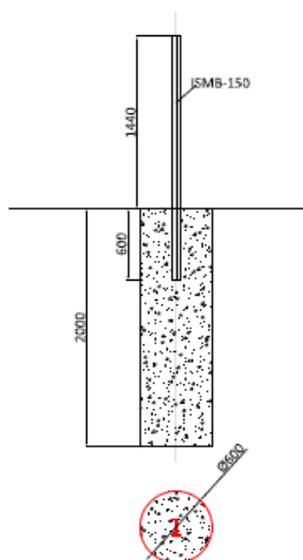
Cimentación con micro pilote. Detalle de cimentación y acabado
